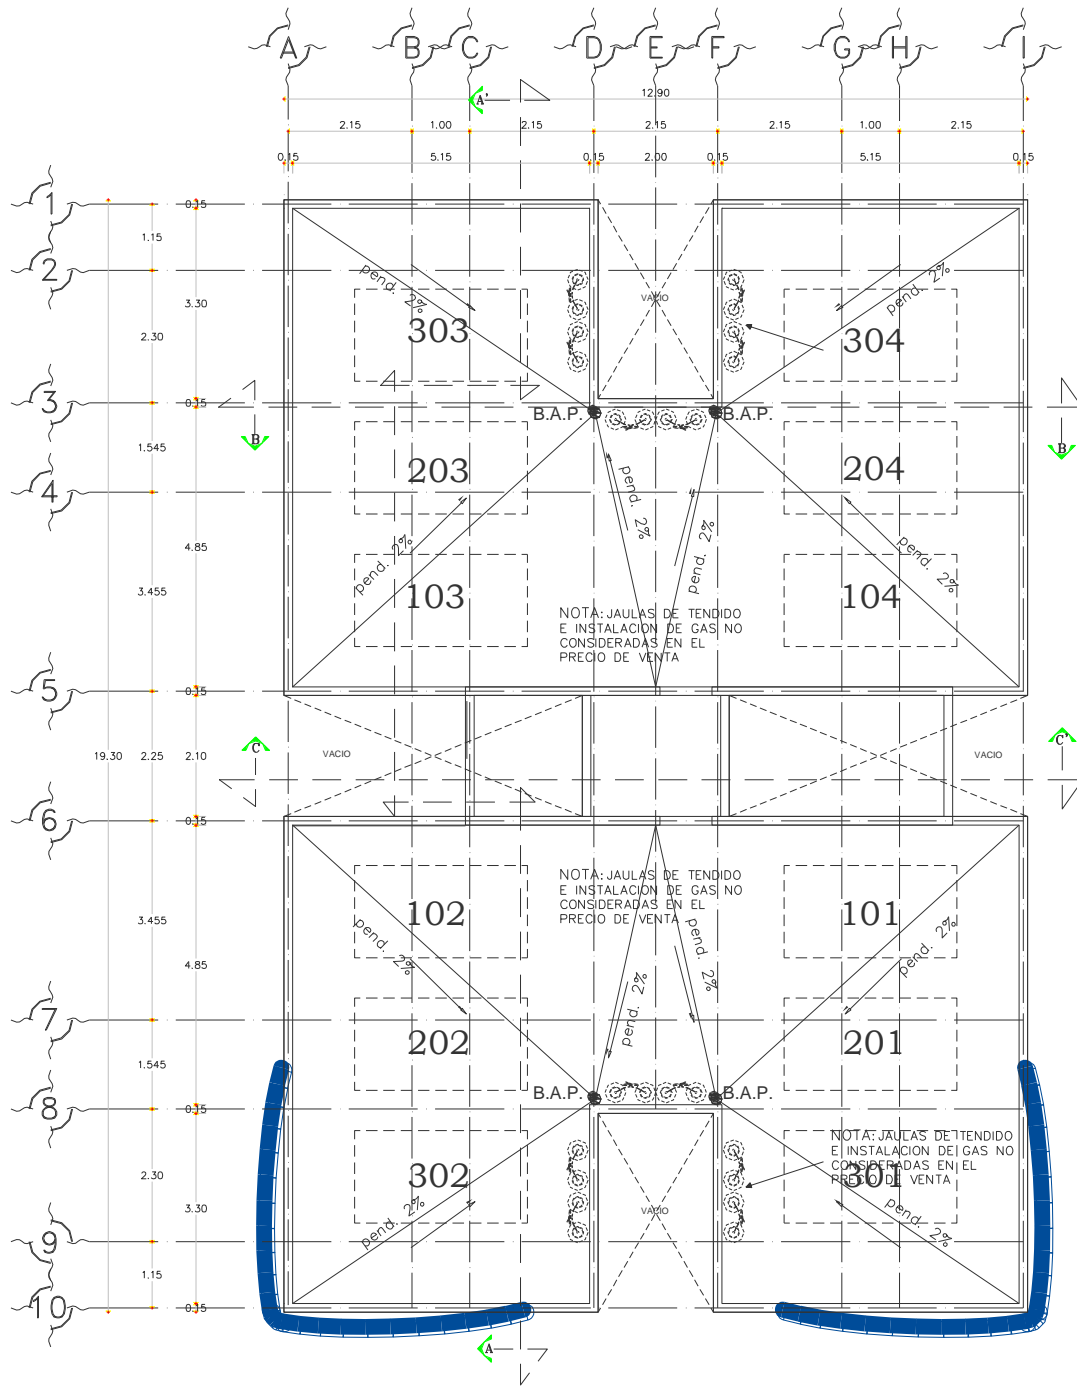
Planta Tipo del Conjunto Habitacional “Norte 70c”
